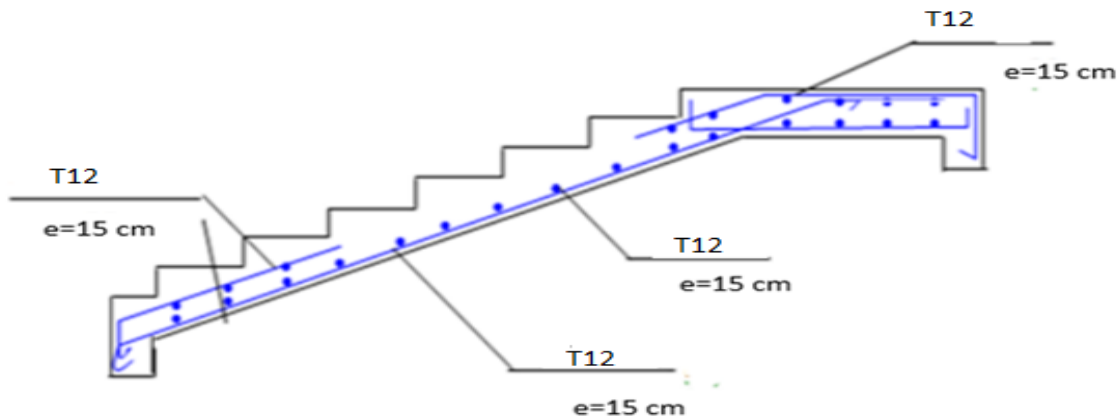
Dessin de ferrailage de l'escalier à paillasse porteuse
